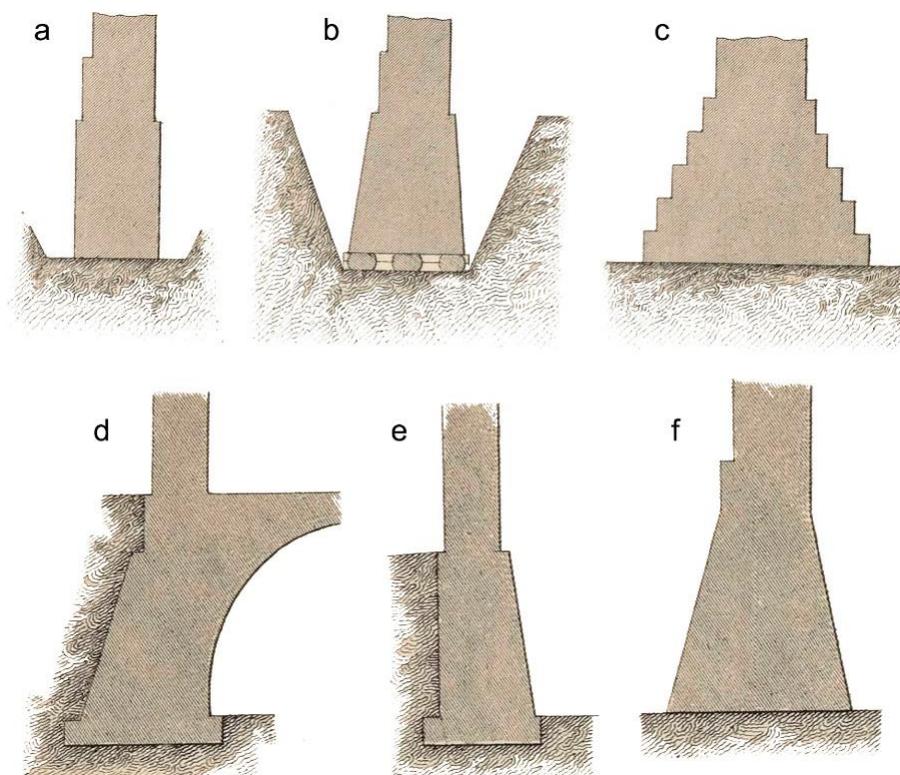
Профили ленточного фундамента [13]: а – фундамент на надежном естественном основании со ступенчатым обрезом; б – фундамент с обрезами, уширением к подошве и
